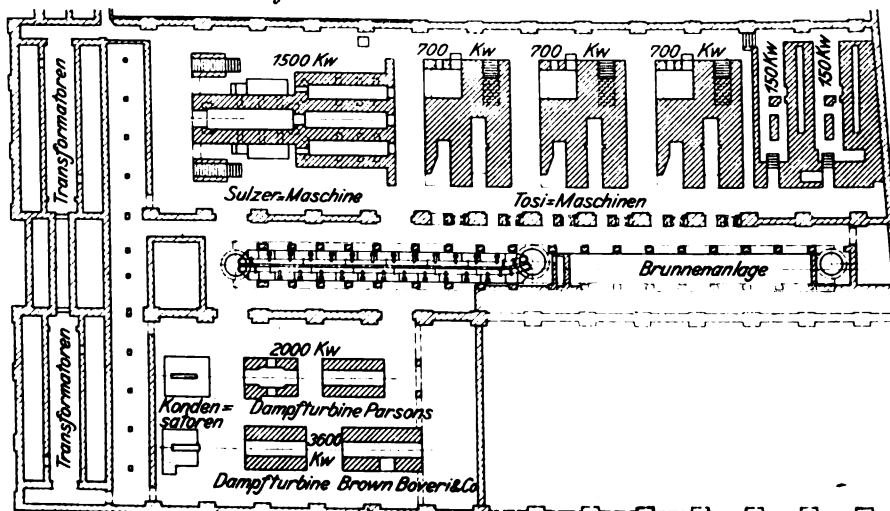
Grundriss des Kraftwerkes Porta Volta.
